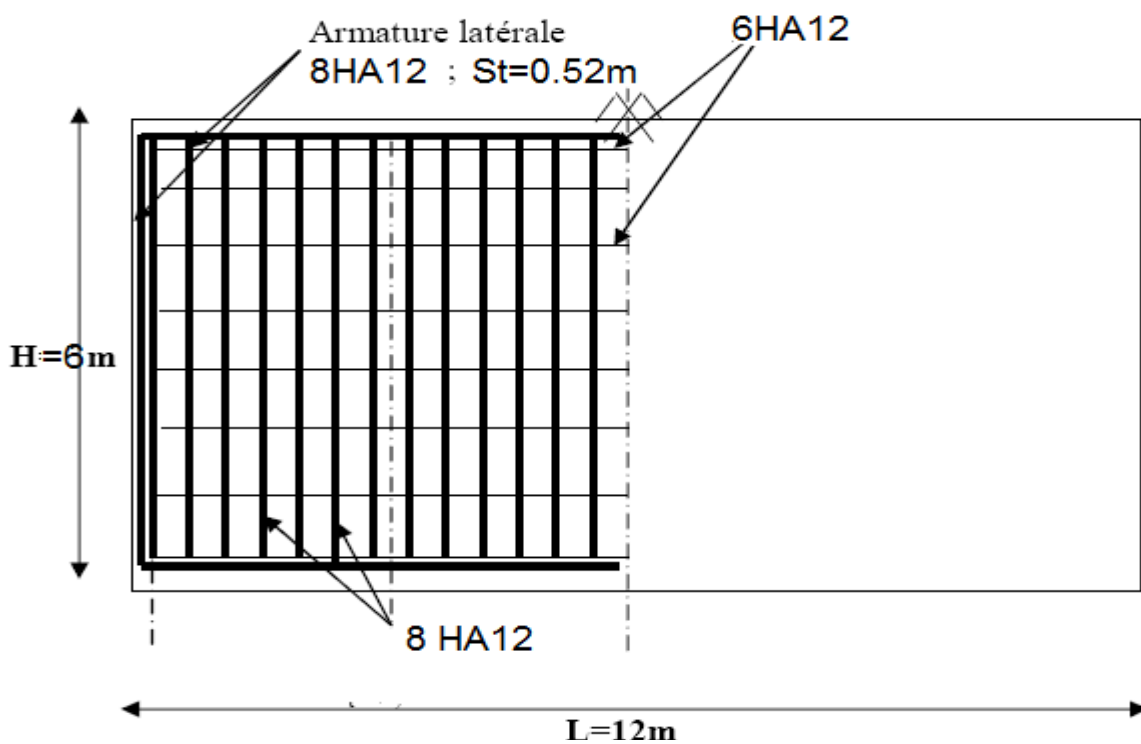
Ferrailage de la semelle (nappe supérieure).
